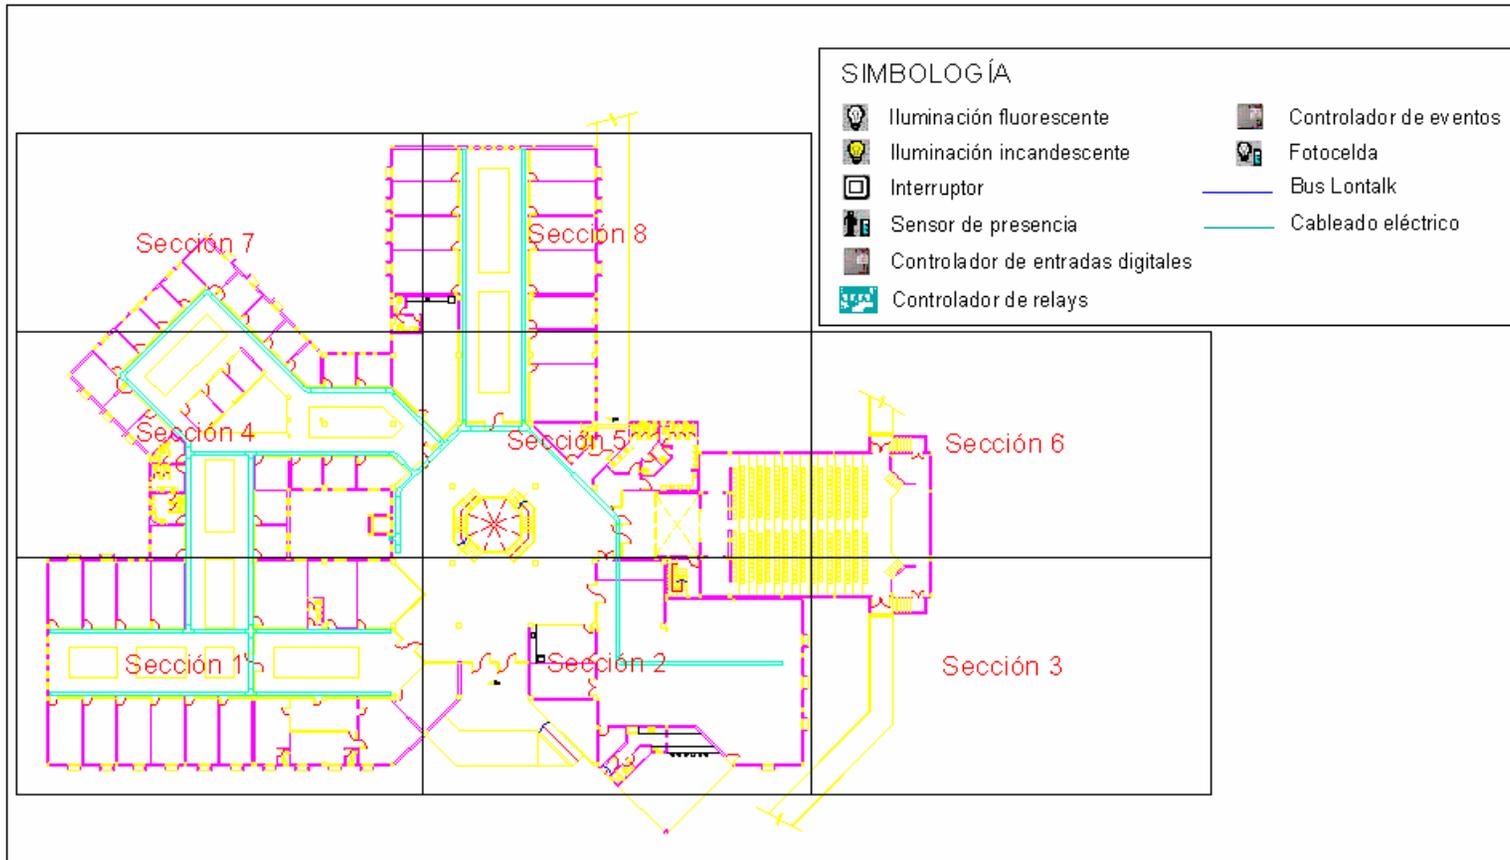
PLANO ILUMINACIÓN PLANTA BAJA GENERAL
